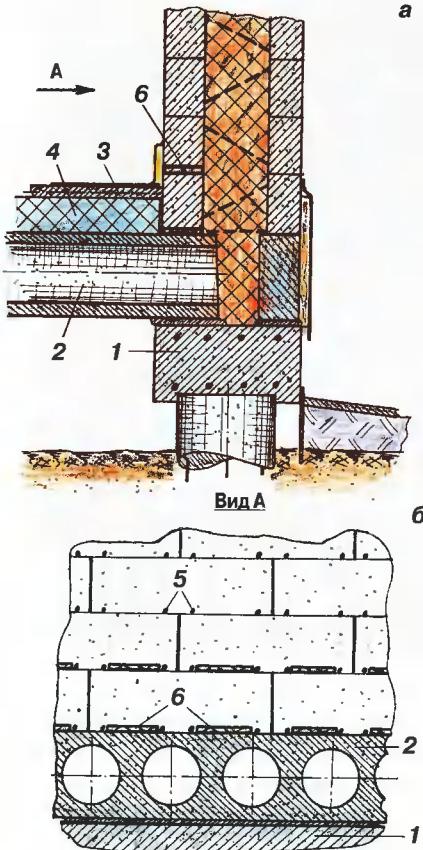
Устройство отсечки холода в зоне опор железобетонных плит перекрытия: а – разрез узла; б – вид А; 1 – ростверк; 2 – плита перекрытия; 3 – половое покрытие; 4 – утеплитель; 5 – отверстия от поперечных штырей форм; 6 – пластины утеплителя
